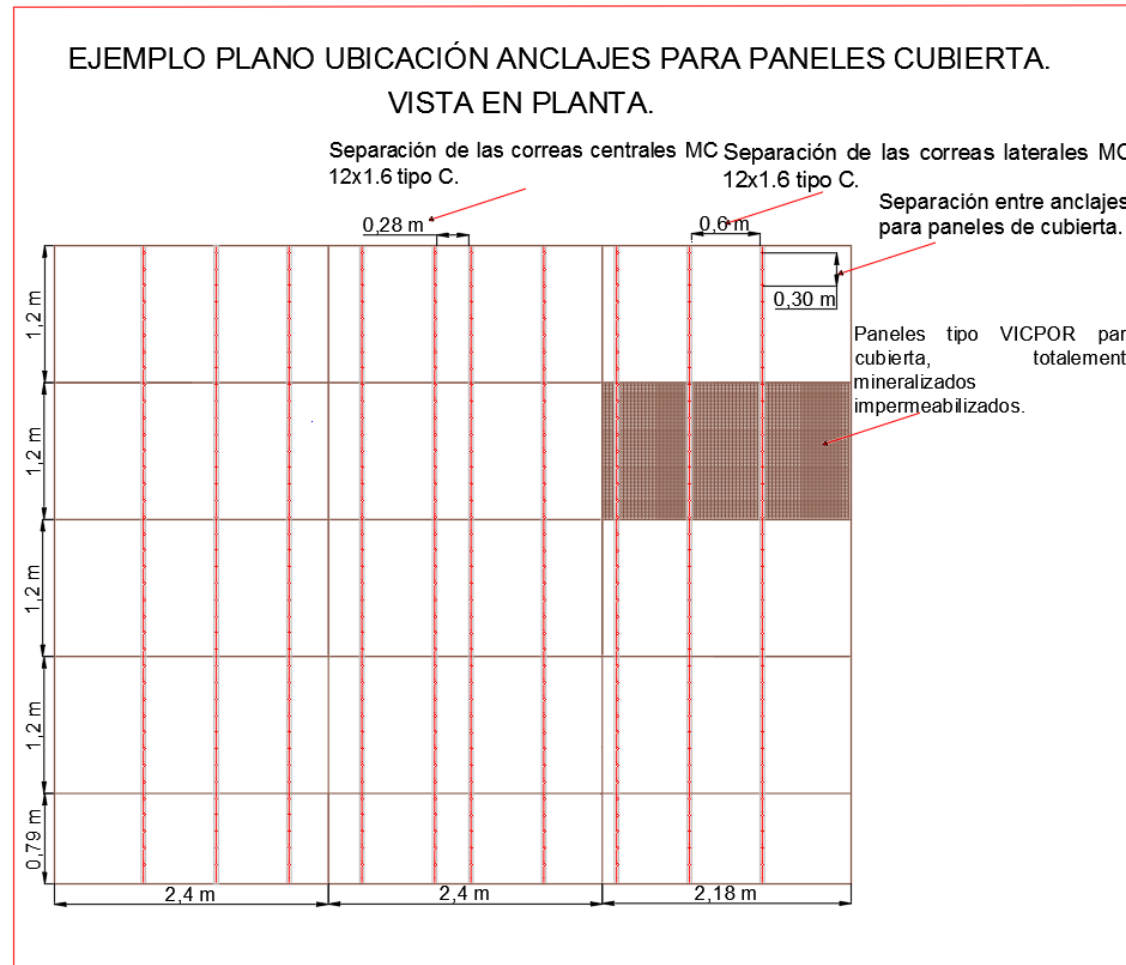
Ejemplo plano modulación de paneles en la cubierta, vista en planta.
